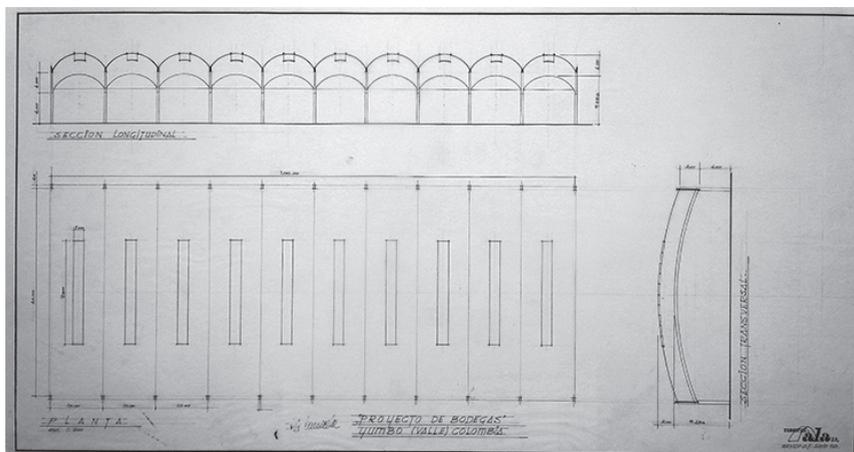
Planos del primer proyecto de Félix Candela para bodegas Almagrán. (Fuente: Avery Architectural and Fine Arts Library, Columbia University, New York).
